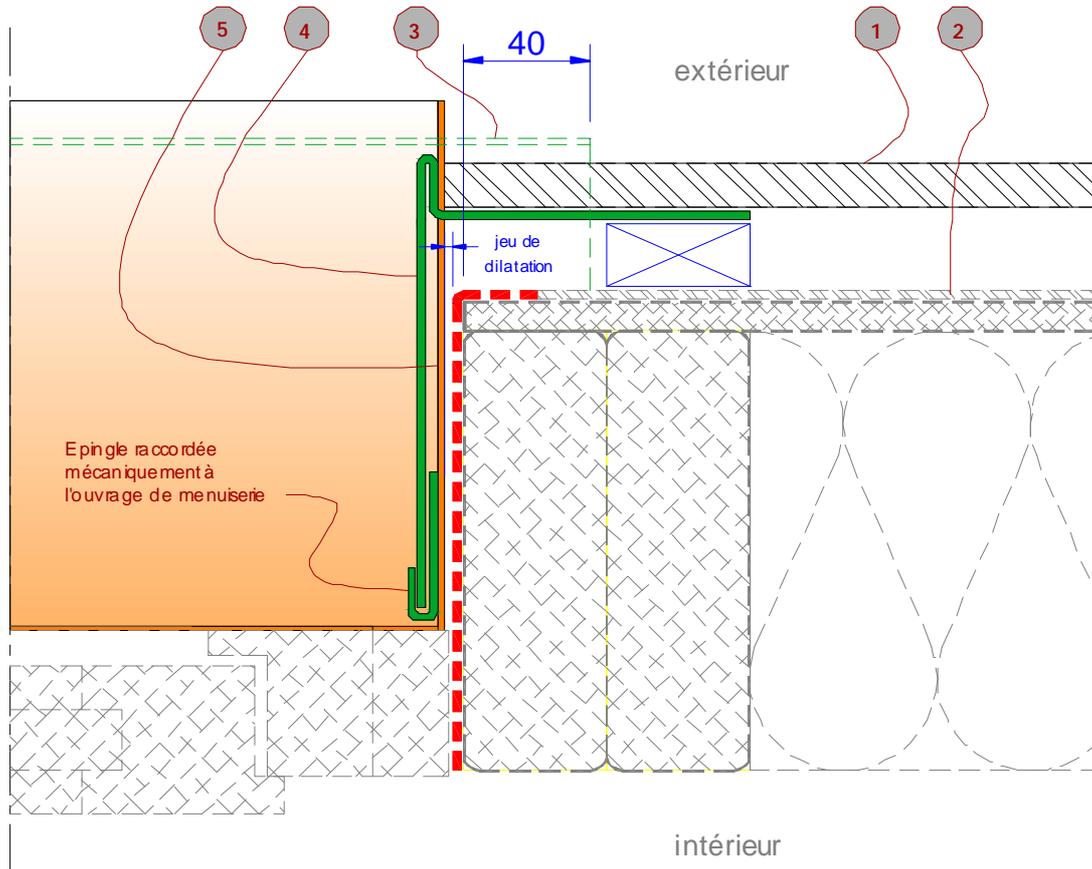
Coupe sur linteau de baie - Pose sur COB,
